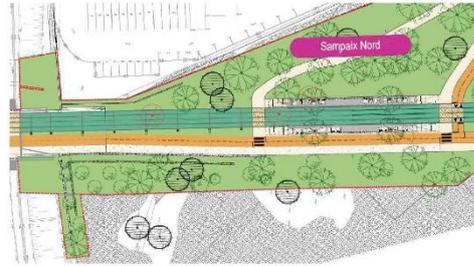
NOUVELLE SECTION AU DROIT DU BOIS DE SAINT-FONS
